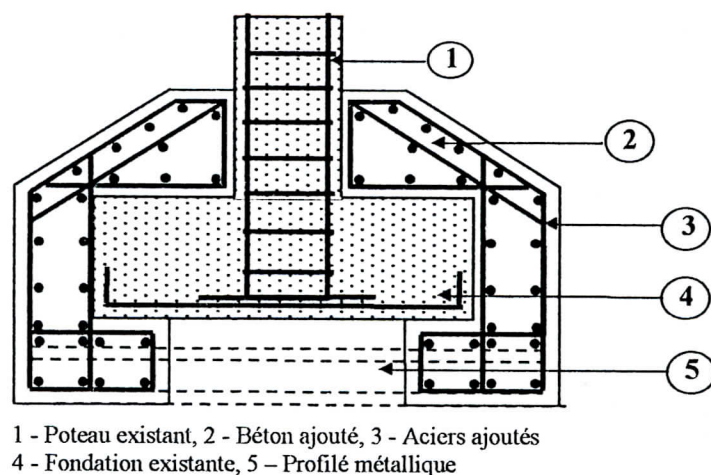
Renforcement des fondations – cas où le poteau n'est pas renforcé [15]
